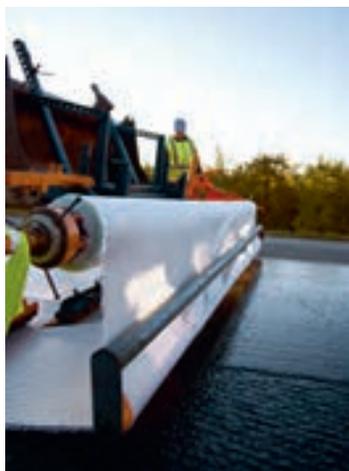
Application d'un géosynthétique anti-fissuration de chaussée (© F. Roussy).
